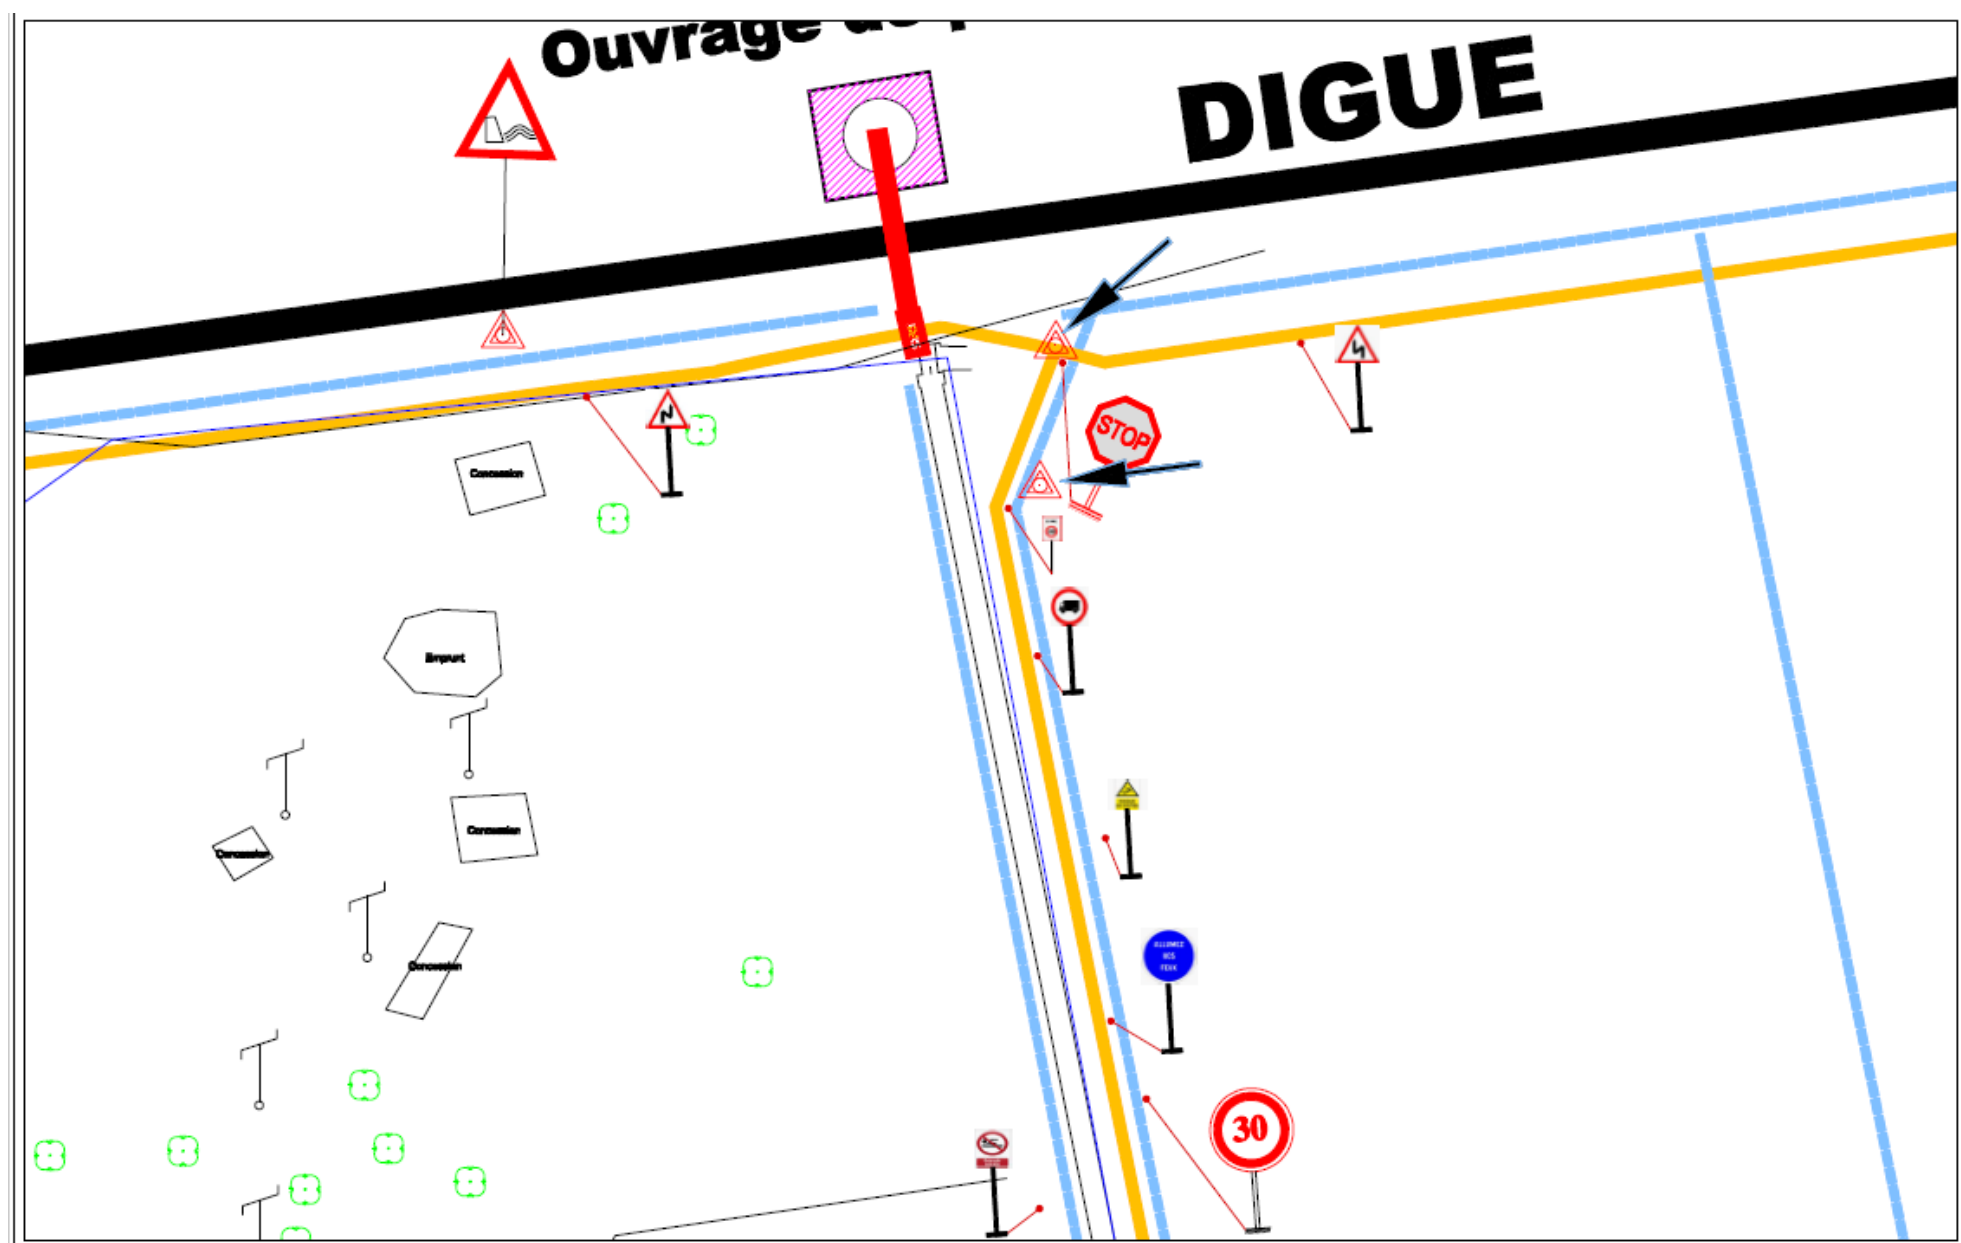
Aperçu du plan de signalisation : zone de captage du barrage
